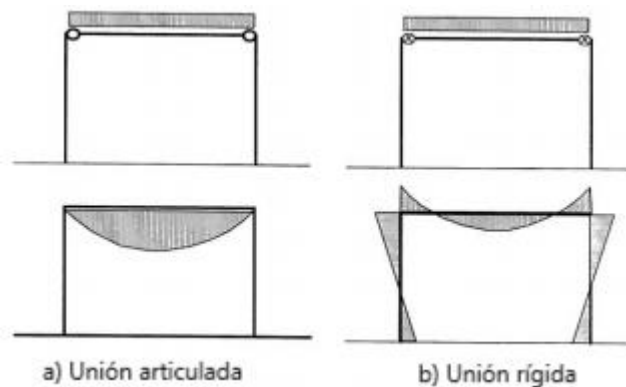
Distribución elástica de momentos flectores en un pórtico simple. (Fuente: *Design of Joints in Steel and Composite Structures*)
